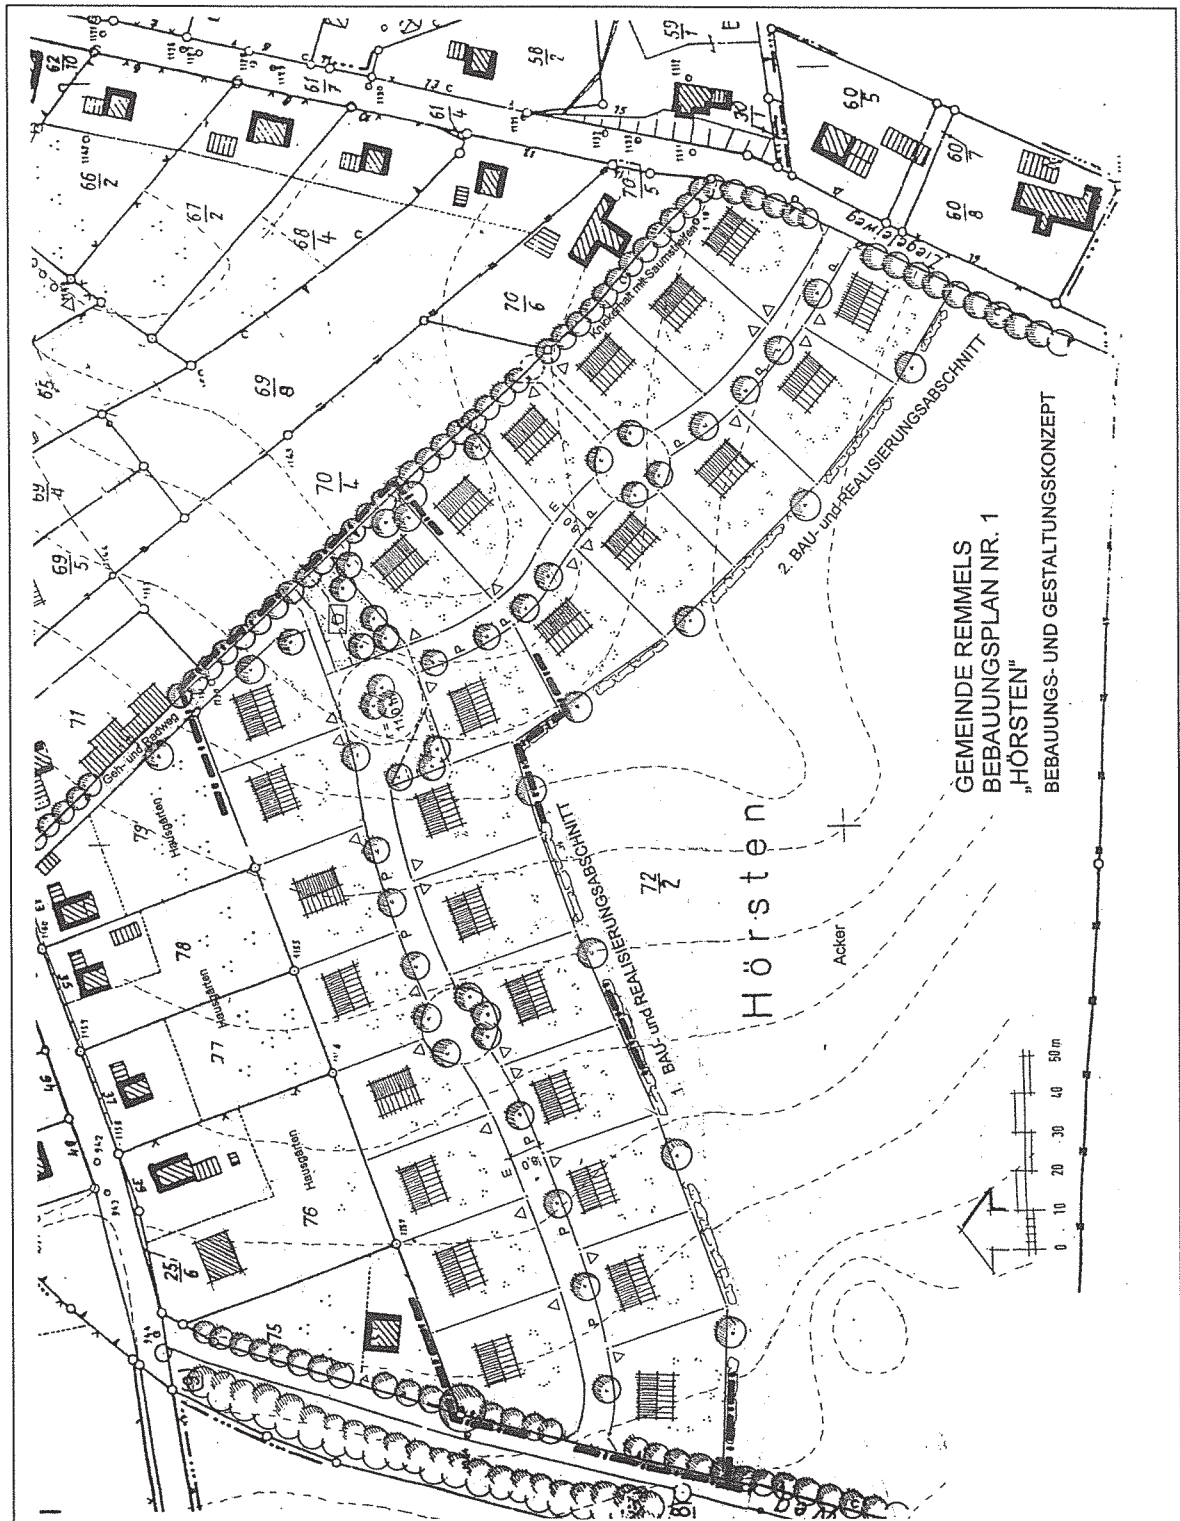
Ausschnitt aus „Bebauungs- und Gestaltungskonzept“ zum Bebauungsplan Nr. 1 vom 15.12.2000 mit Darstellung des 1. und 2. Bauabschnittes und der innenliegenden Grundstücksflächen als 3. Bauabschnitt, unmaßstäblich
